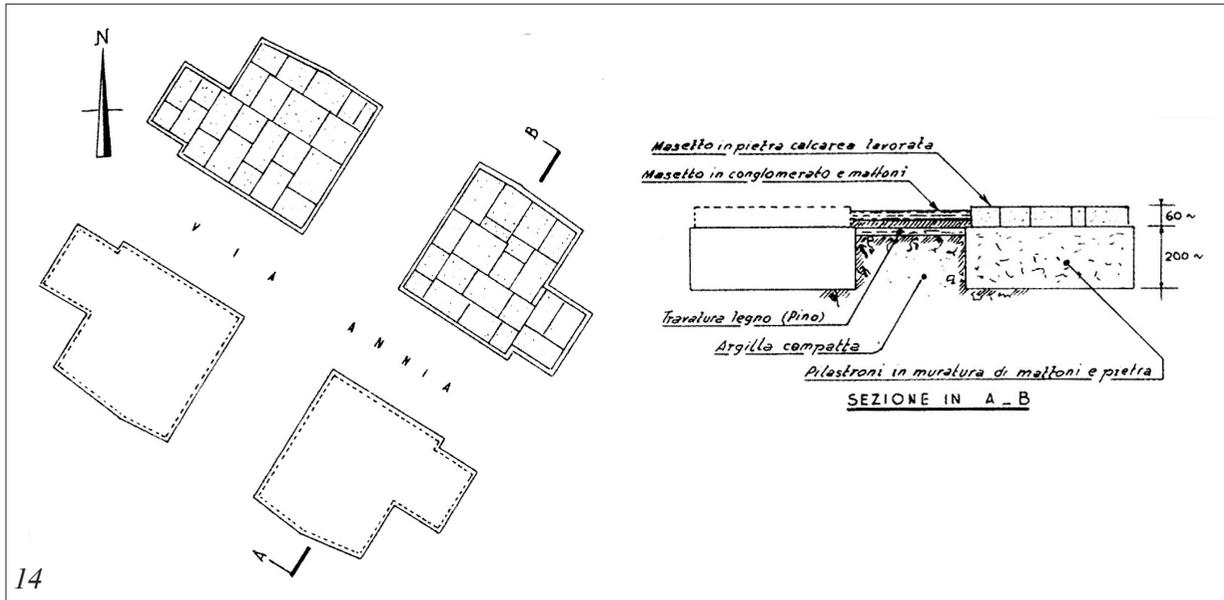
Pianta e sezione delle strutture rinvenute negli scavi del 1964-1965 (rielaborazione da TIUSSI 2001).
